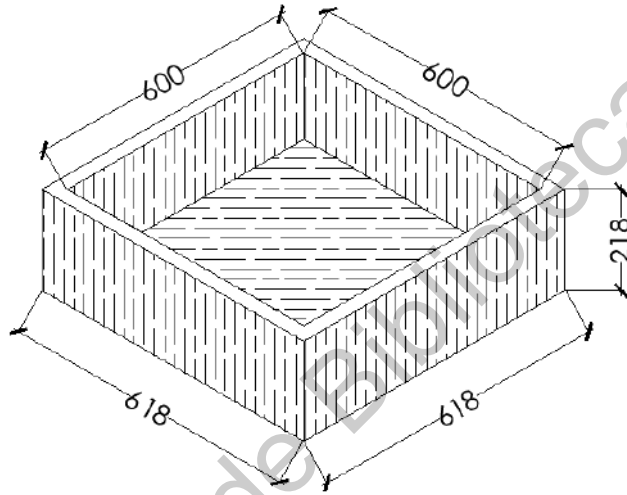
Dimensiones internas y externas del molde de triplay usado como cimbra.
